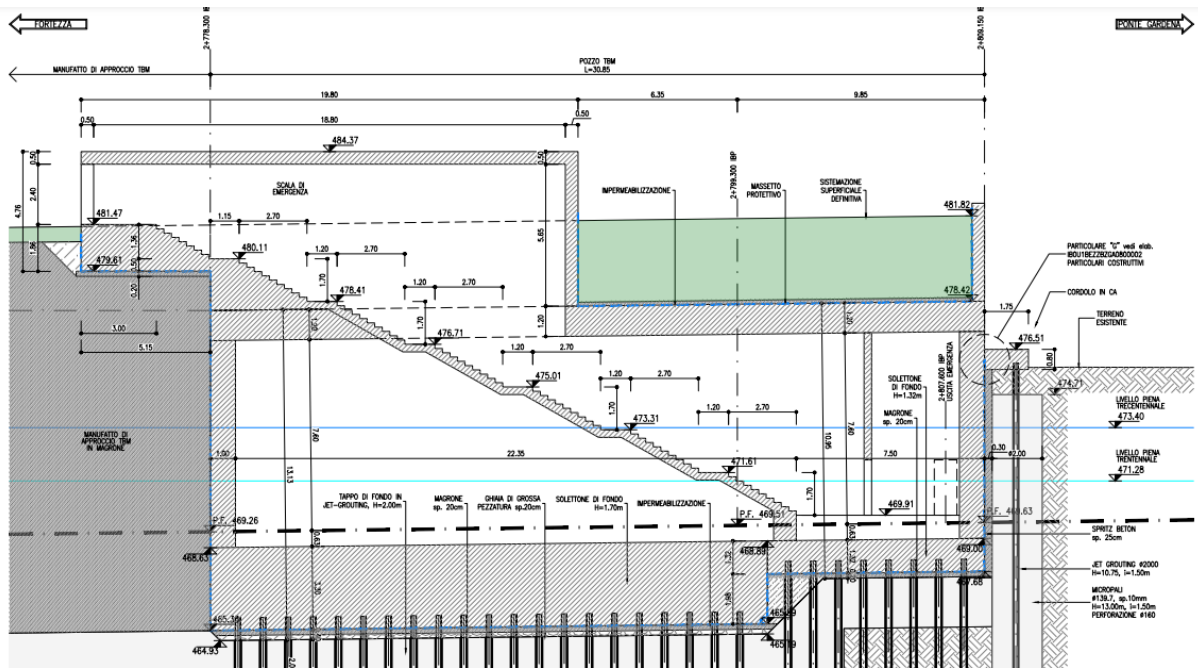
Sezione scala Interconnessione Ponte Gardena
